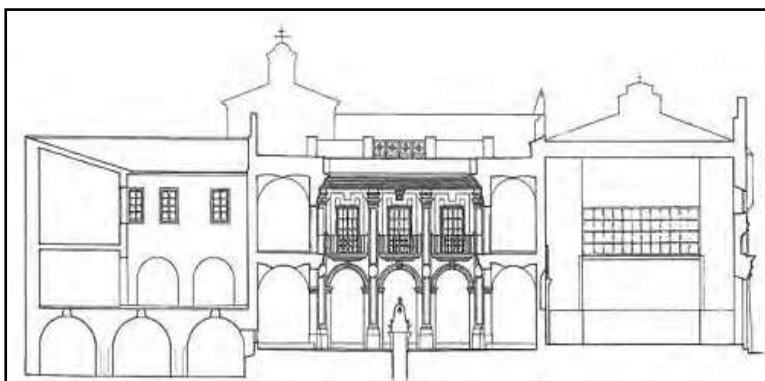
Convento de Santa Lucía. Elche (Alicante). Sección norte-sur con la situación de la iglesia, patio central y baños. Màrius Bevià.
